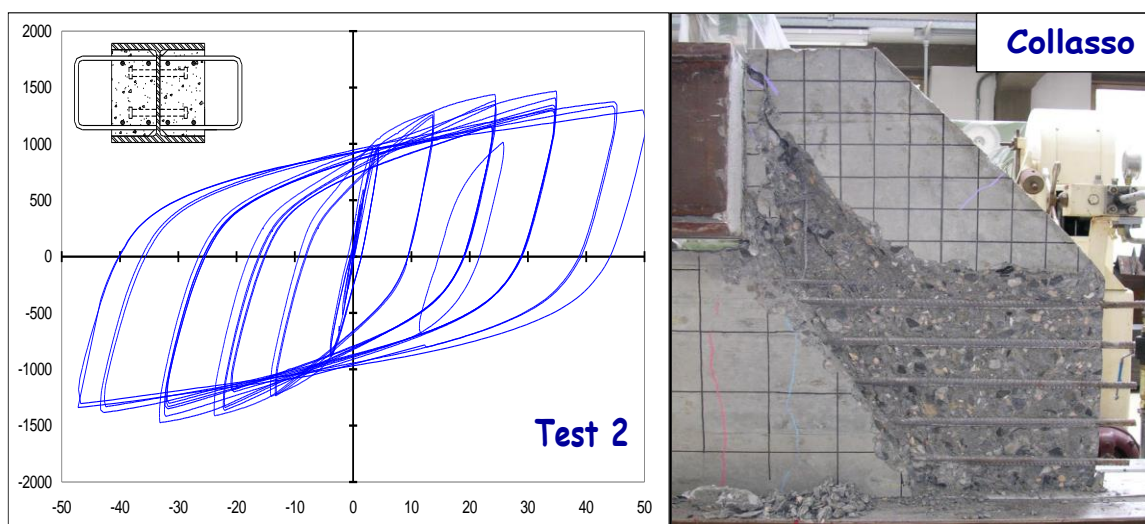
prove di laboratorio su connessioni trave-colonna in sezione mista acciaio-calcestruzzo
